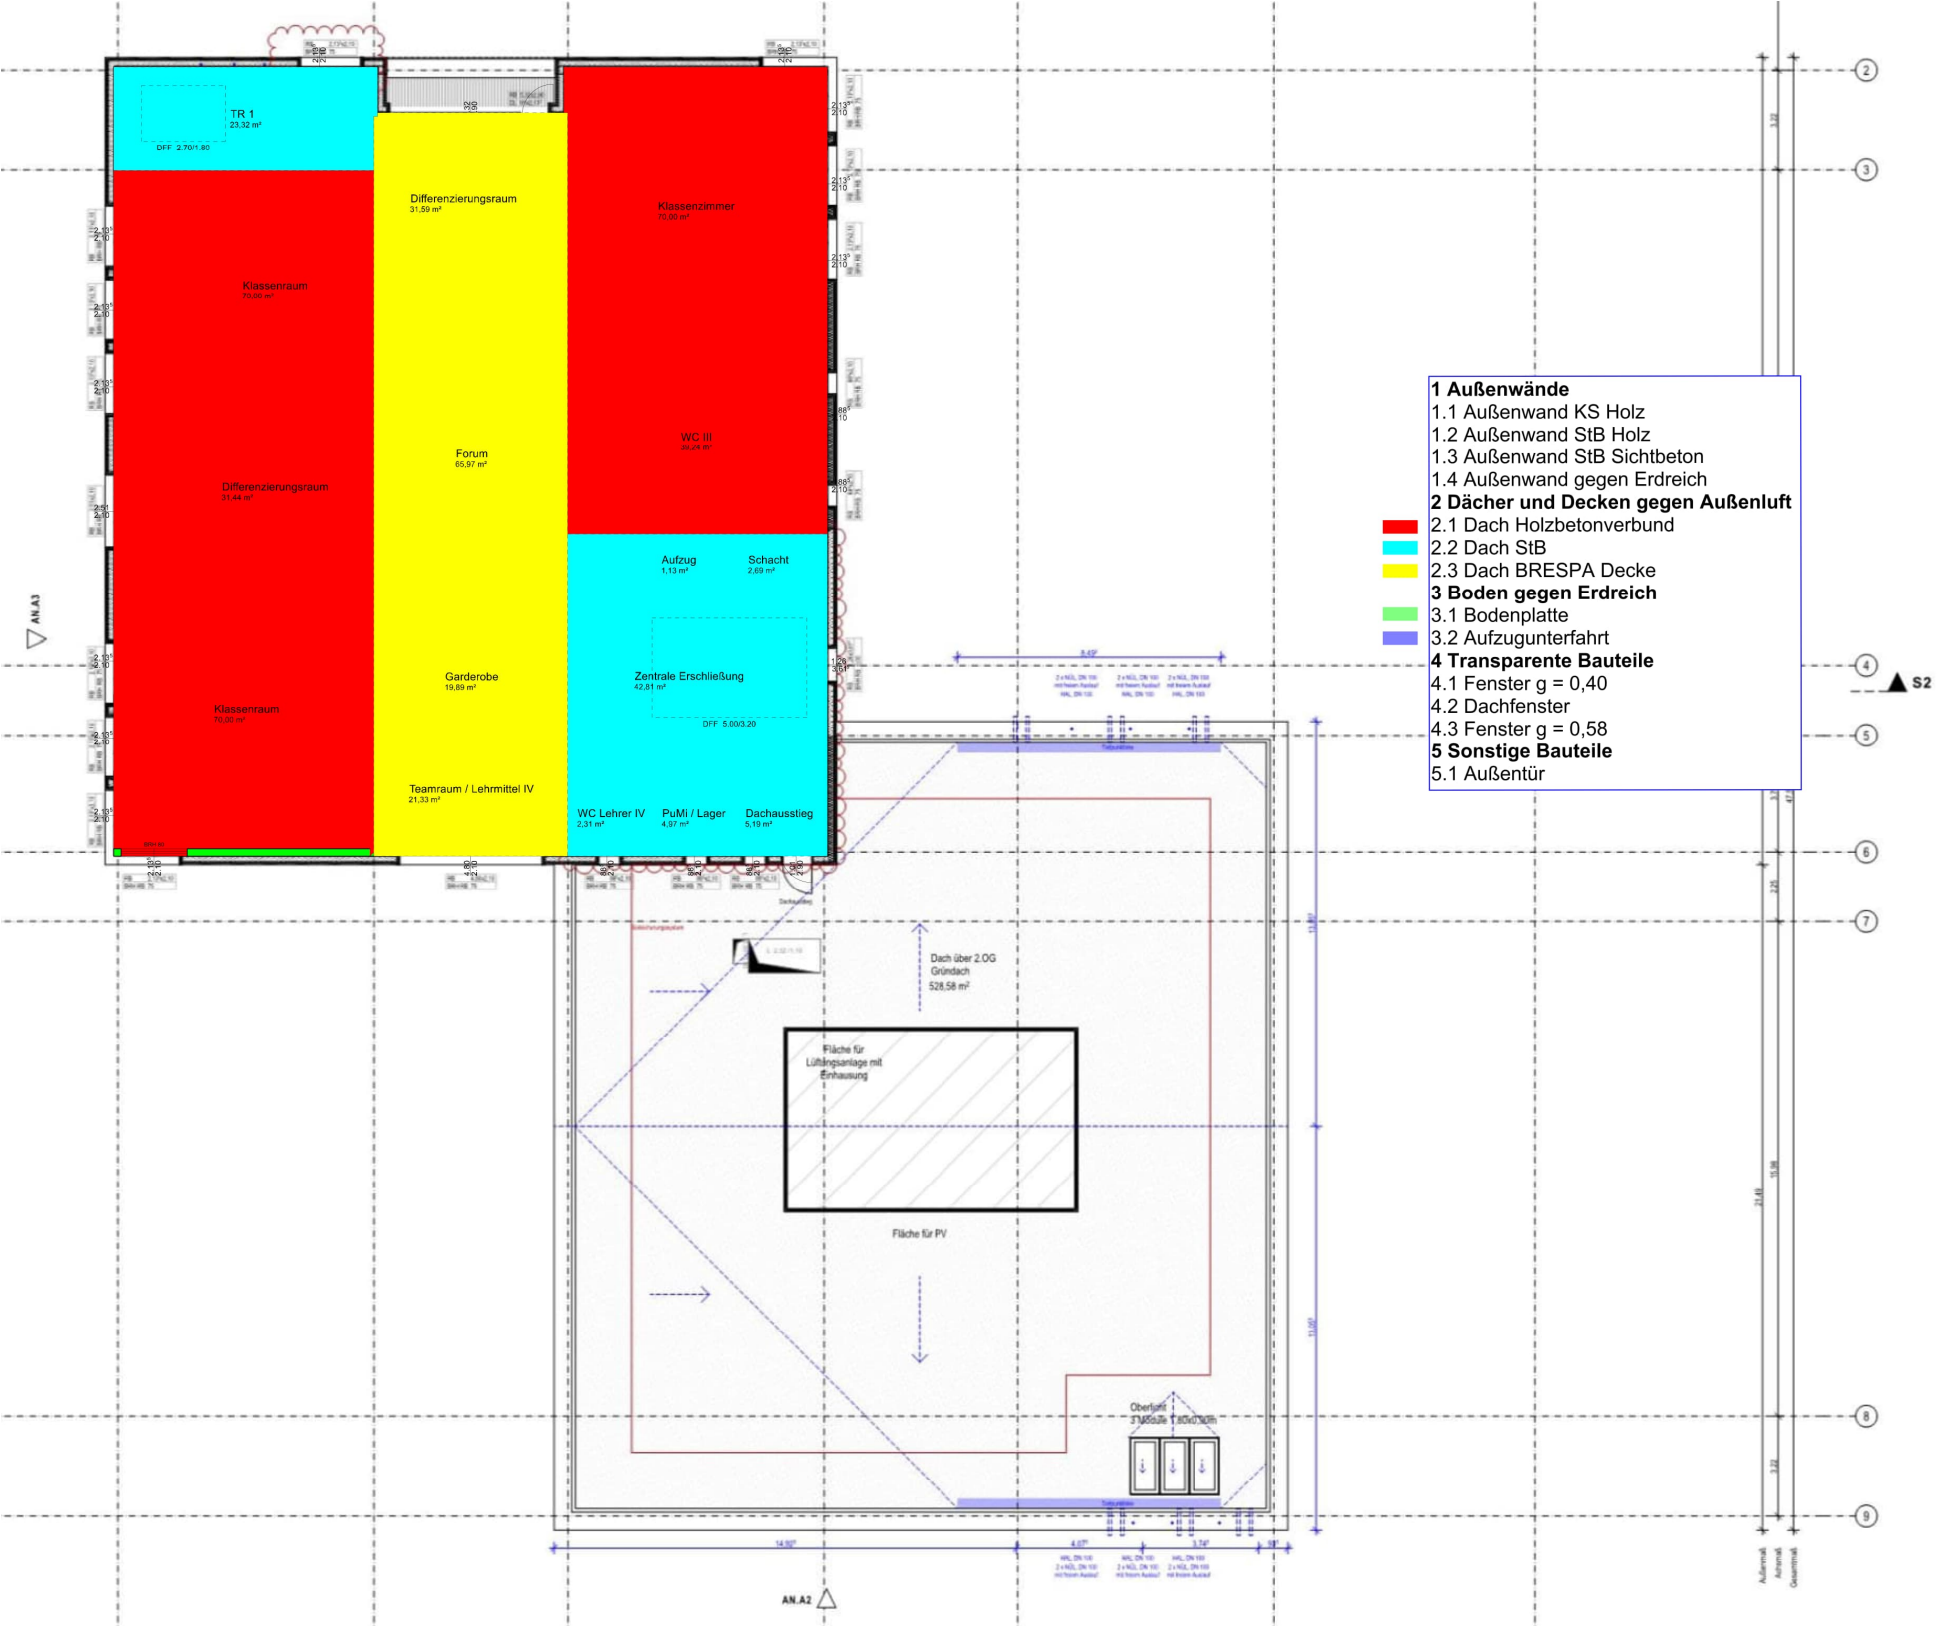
Bauteile Dachflächen Grundriss 3. OG
